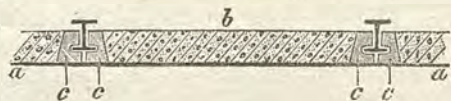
Solaio in calcestruzzo di getto con mattoni d'imposta.
